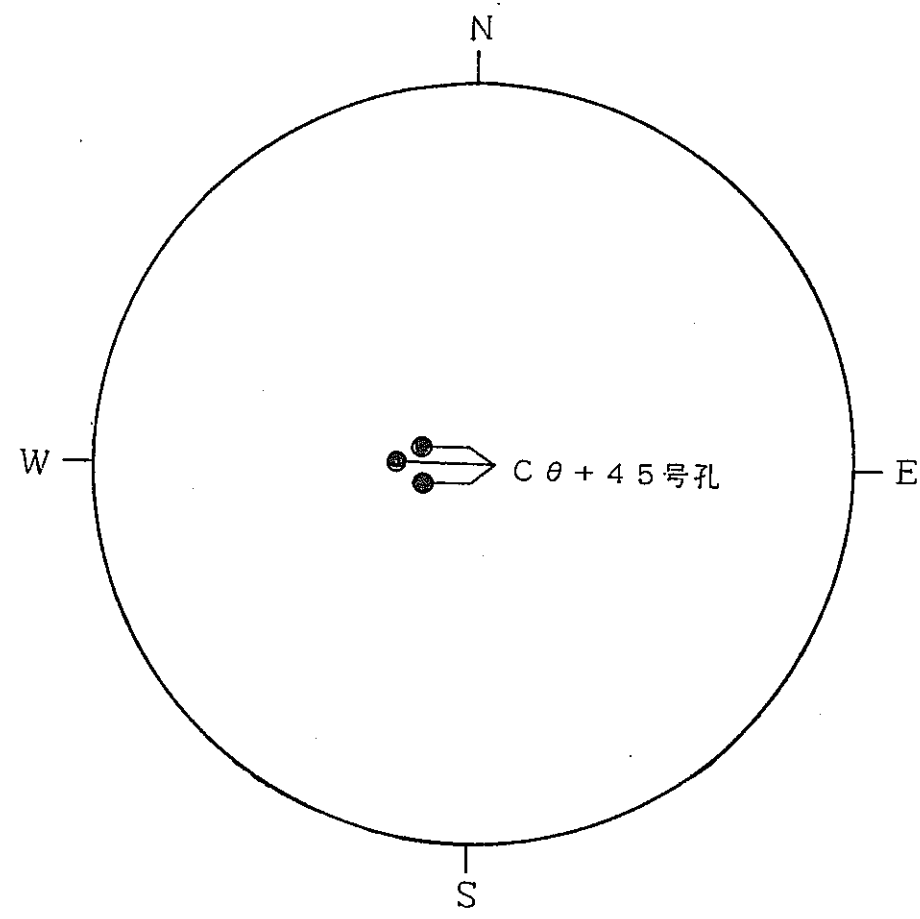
コア採取位置図 (H2-V-1 豎坑)
